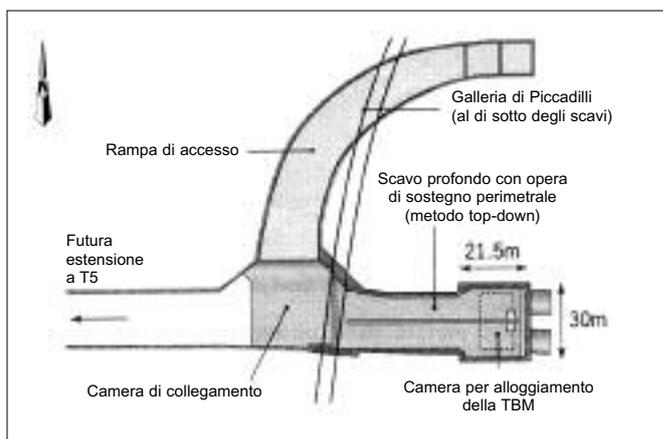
Ubicazione del pozzo indicato TBM chamber delle dimensioni in pianta di 21.5 m per 30 m
